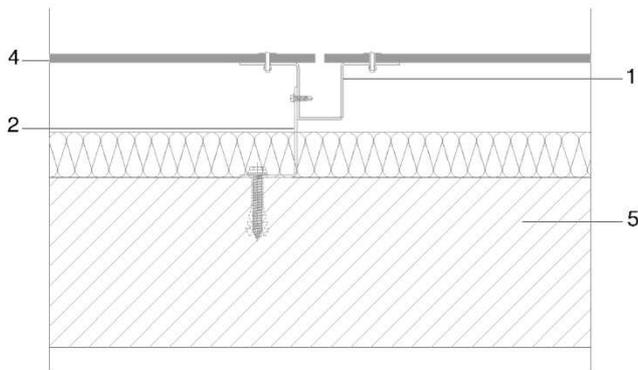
Sección horizontal con perfil  $\Omega$ .
